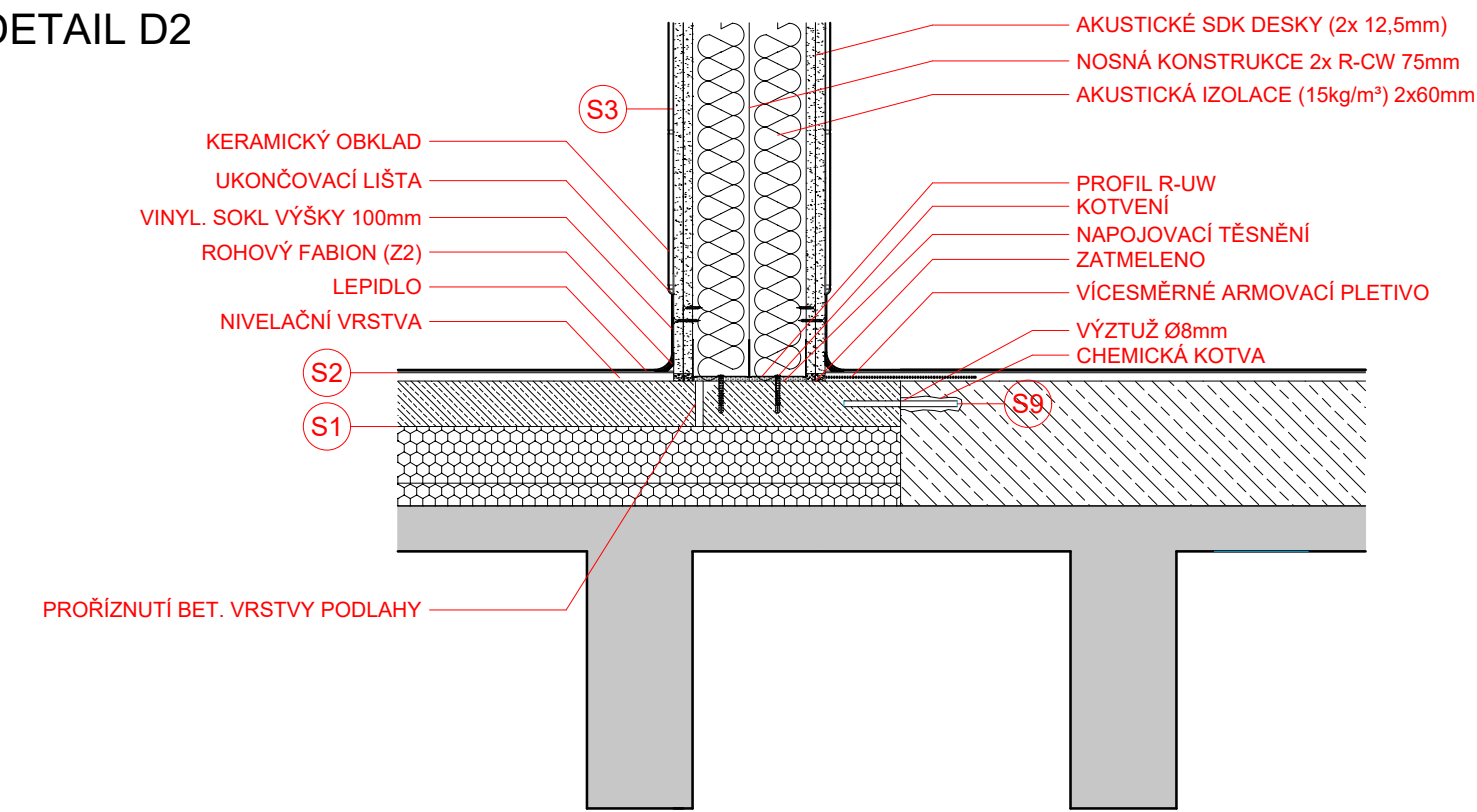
DETAIL NAPOJENÍ SDK KONSTRUKCÍ M1:10
